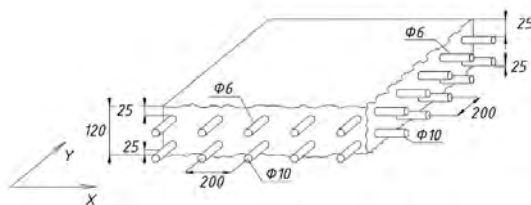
Оптимальный вариант конструирования плиты перекрытия
